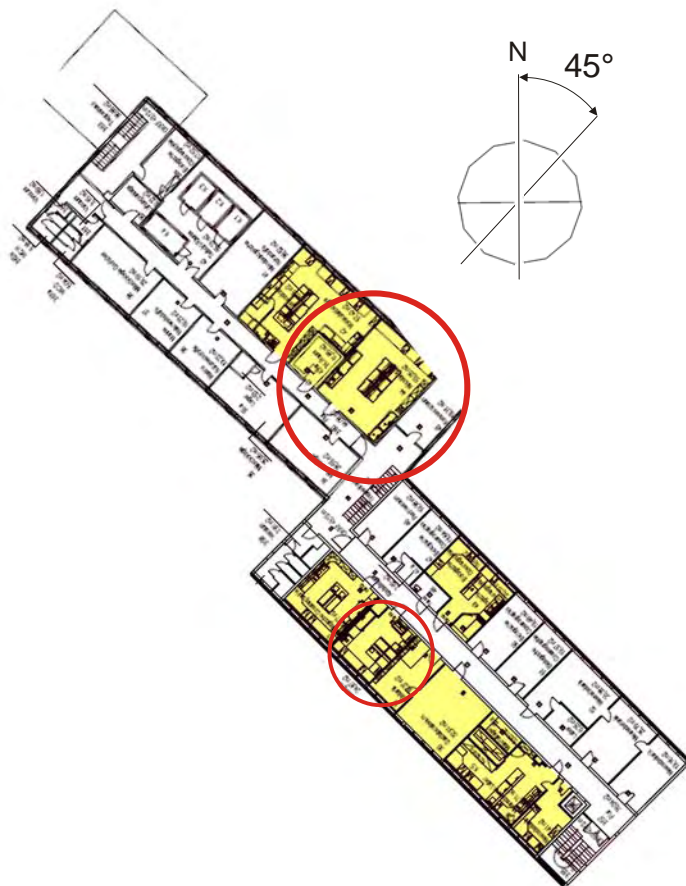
Grundriss Dachgeschoss mit schematischer Lage der untersuchten thermischen Zonen mit Nordpfeil und Drehung gegenüber Nord
